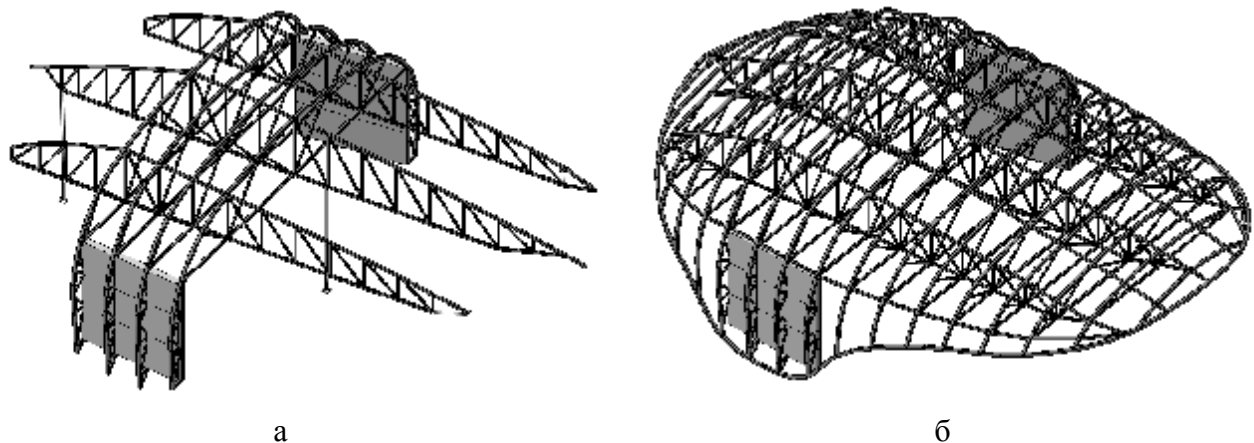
3-D модель основных несущих конструкций покрытия здания передающие их на железобетонную часть здания; железобетонные диафрагмы жесткости, обеспечивающие пространственную неизменяемость; три основные несущие продольные фермы покрытия. Затем были проработаны поперечные шпангоуты, стрингеры и обвязочный контур (рис.3б).
